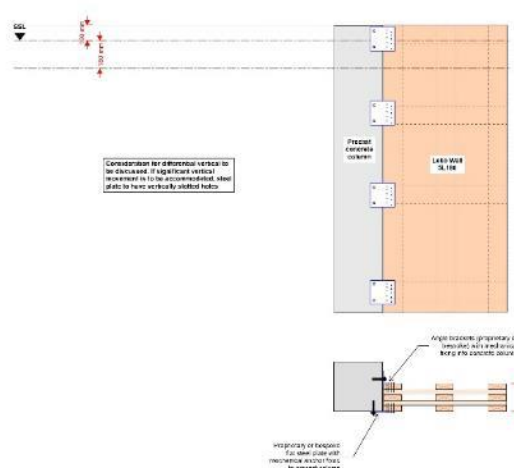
Exemple de Connexion entre un mur LEKO LABS et une colonne béton
